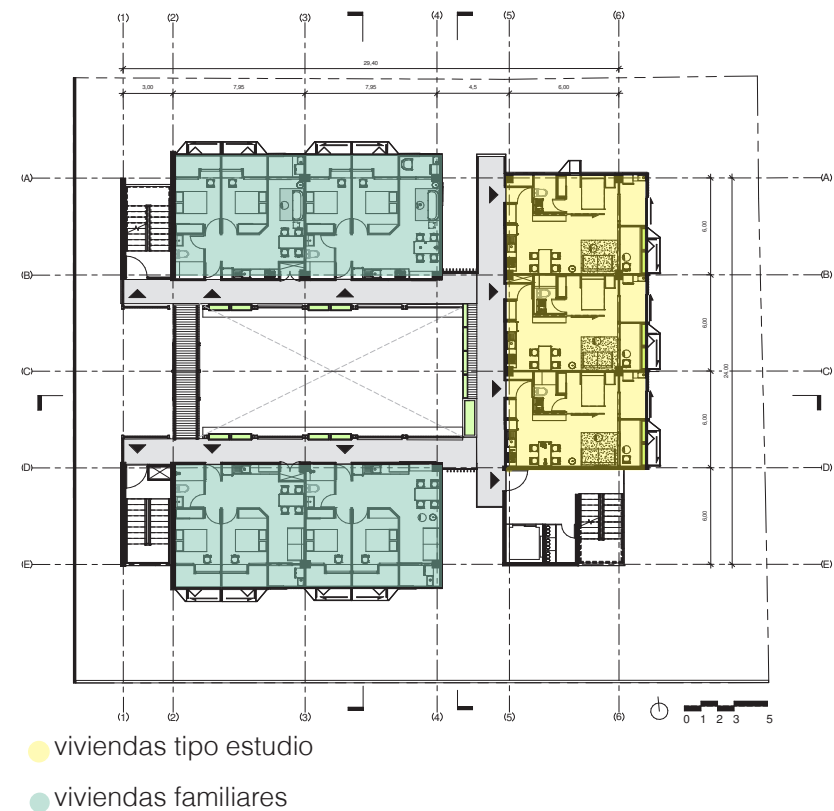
Planta típica de vivienda. Fuente propia.
